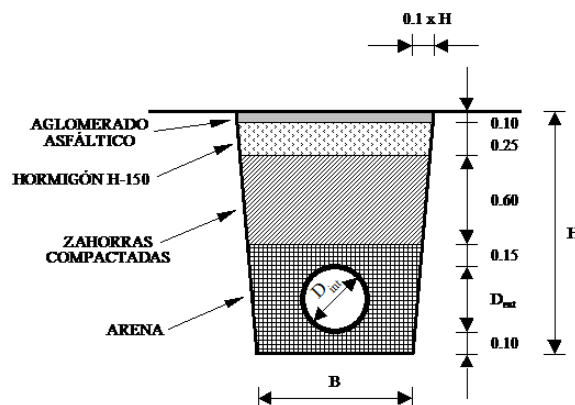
Zanja trapezoidal ($D > 600$ mm)
